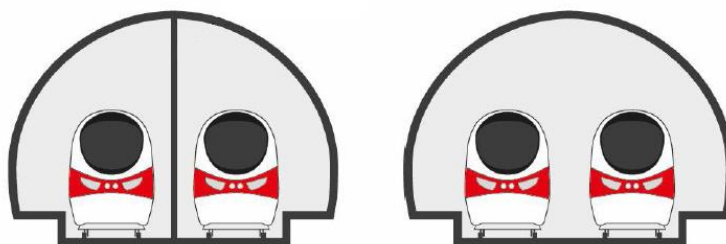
Двухпутный тоннель с разделительной стеной – перегородкой и без неё
